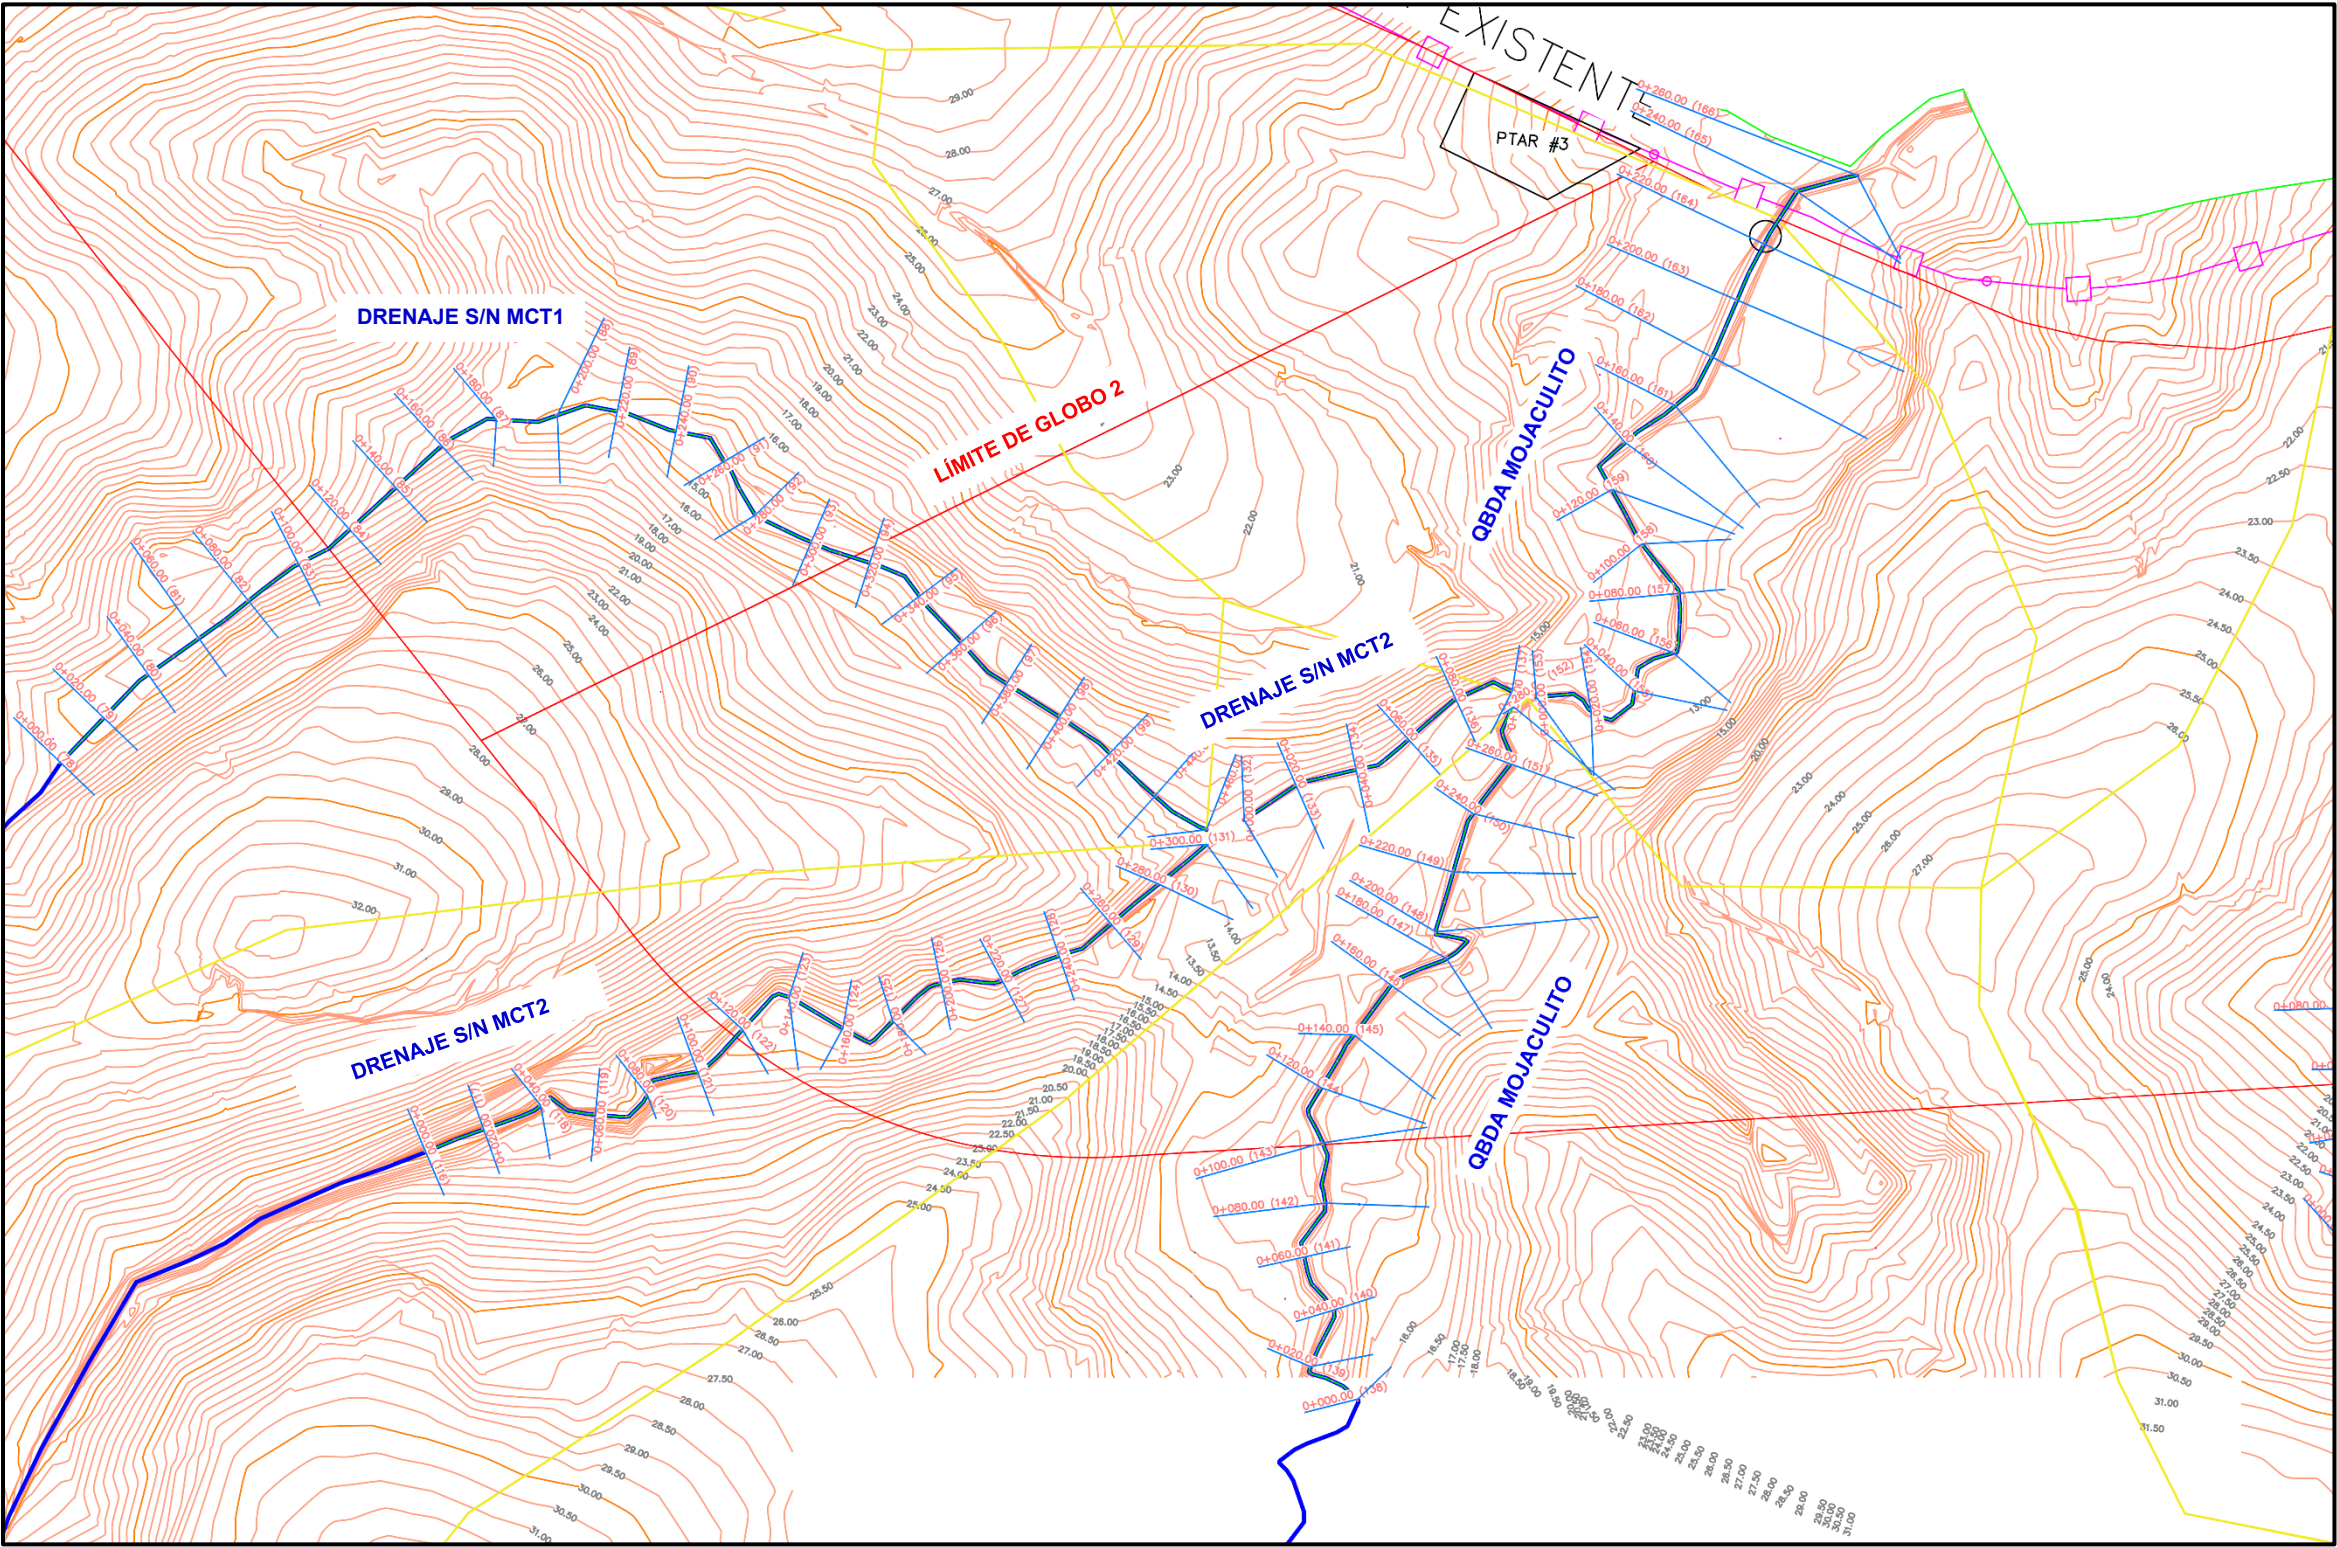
Vista de planta de la topografía en detalle en cauce de drenaje Sin Nombre MCT1, en la zona de proyecto Ciudad del Este.
